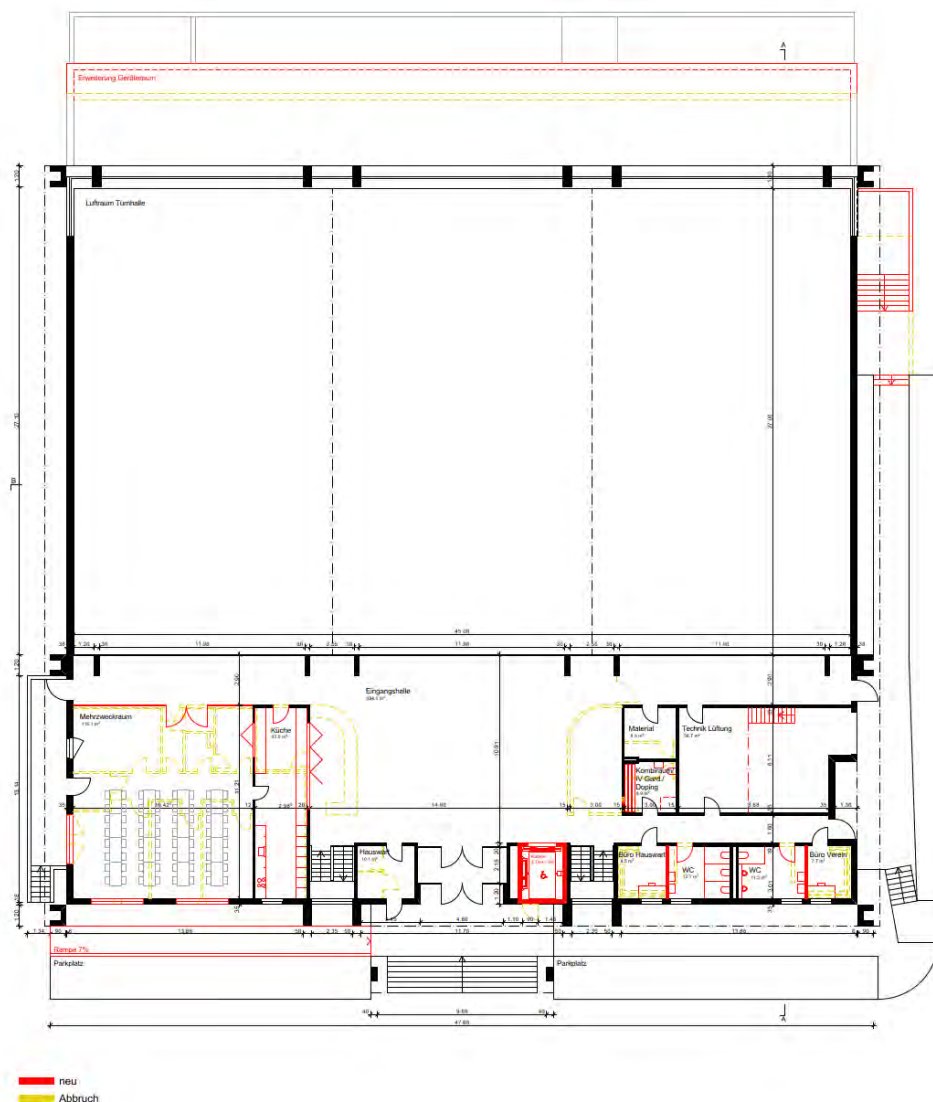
Grundriss oberes Erdgeschoss
